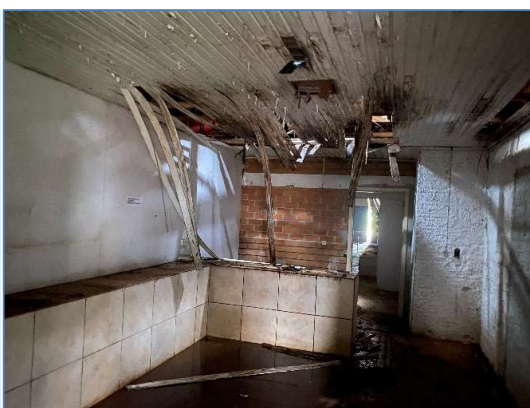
vista do salão, deterioração dos revestimentos e pisos, infiltrações, danos nos forros e cobertura, falta de conservação e manutenção.
